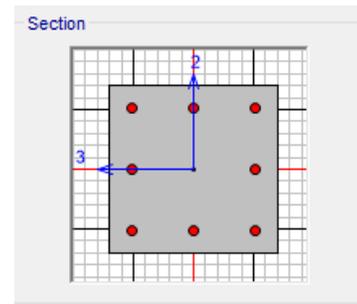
Secciones de vigas y columnas. Fuente: Propia
